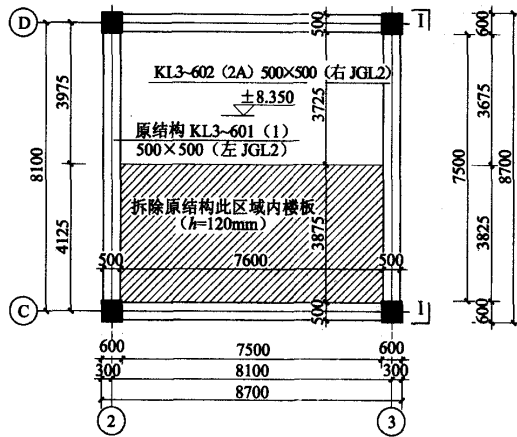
拟新增 4 号楼梯原结构第 3 层钢筋混凝土楼板拆除平面图
